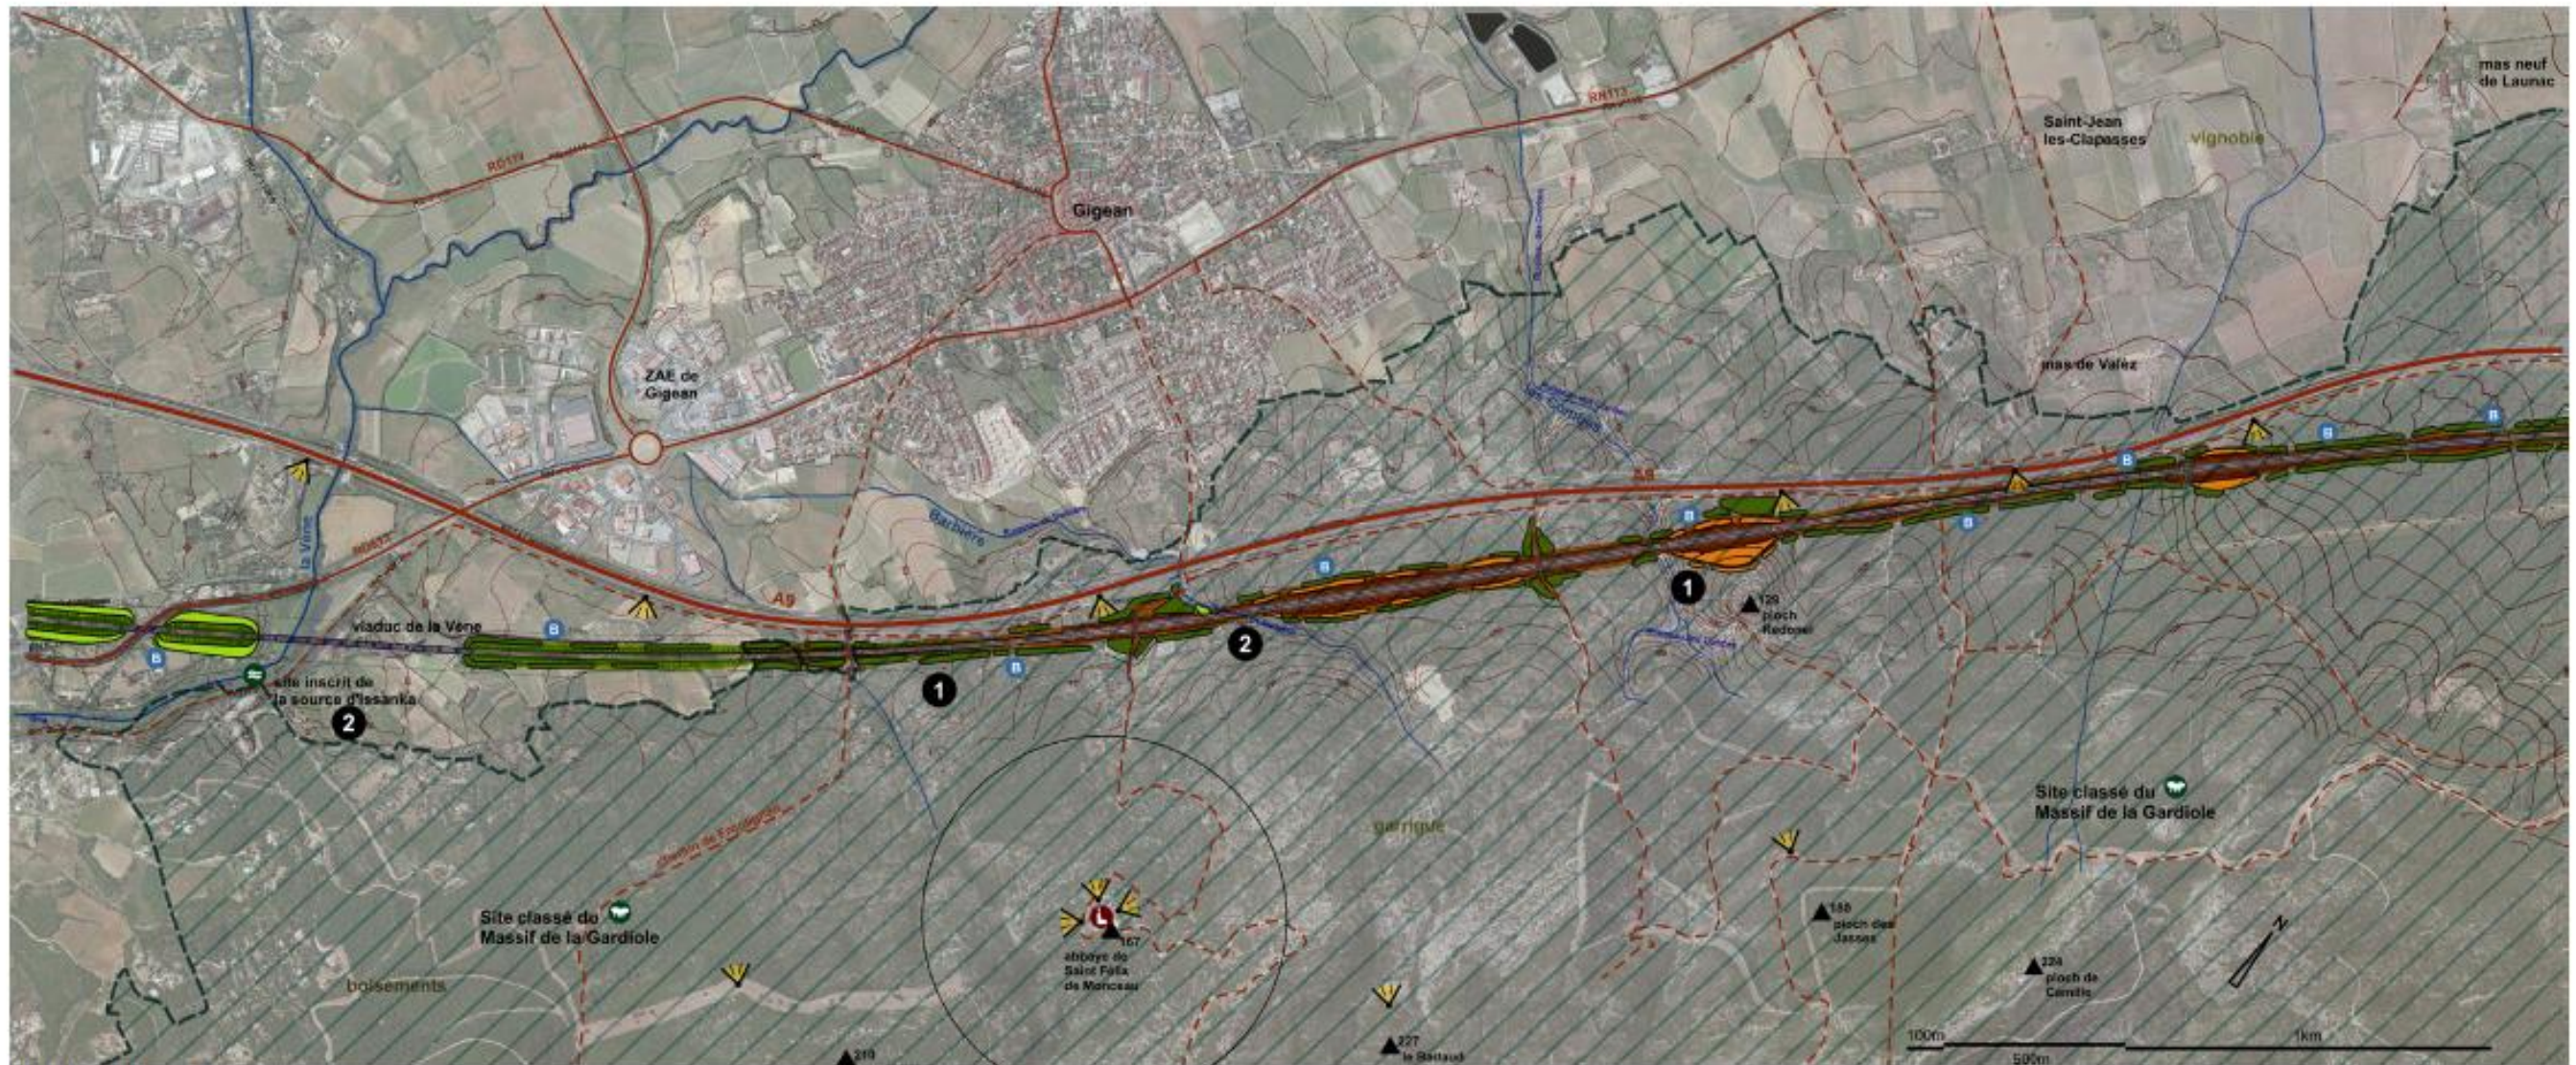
plan des mesures paysagères dans la traversée de la Gardiole (planche 1) (source : Traverses)
